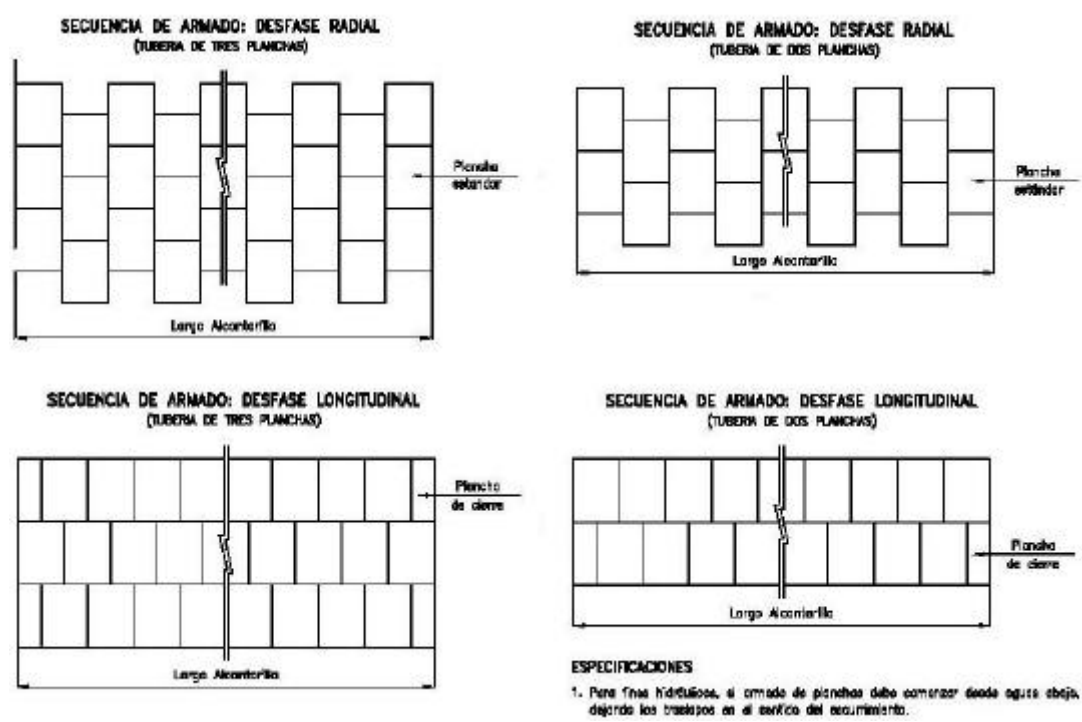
Secuencia de armado de los tubos de acero corrugado.
